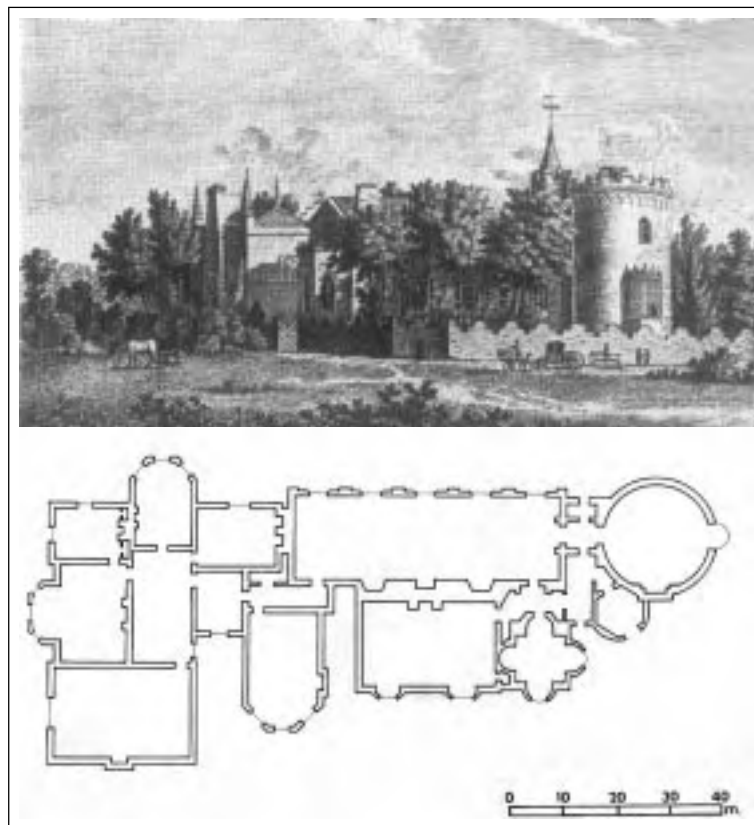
Horace Walpole. Strawberry Hill. Planta e Vista Norte, 1748-77.
